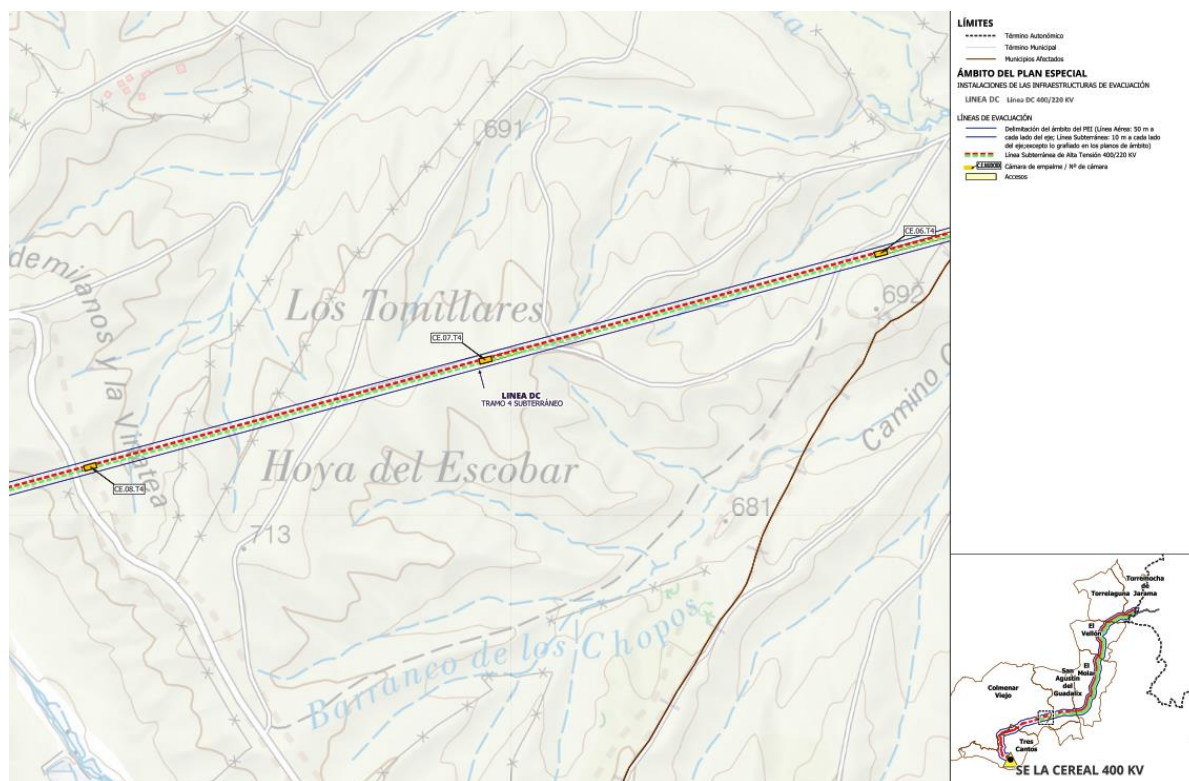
Plano de Ordenación O2.1.19. Planta por tramos. LASAT 400/220 Kv – Línea DC
